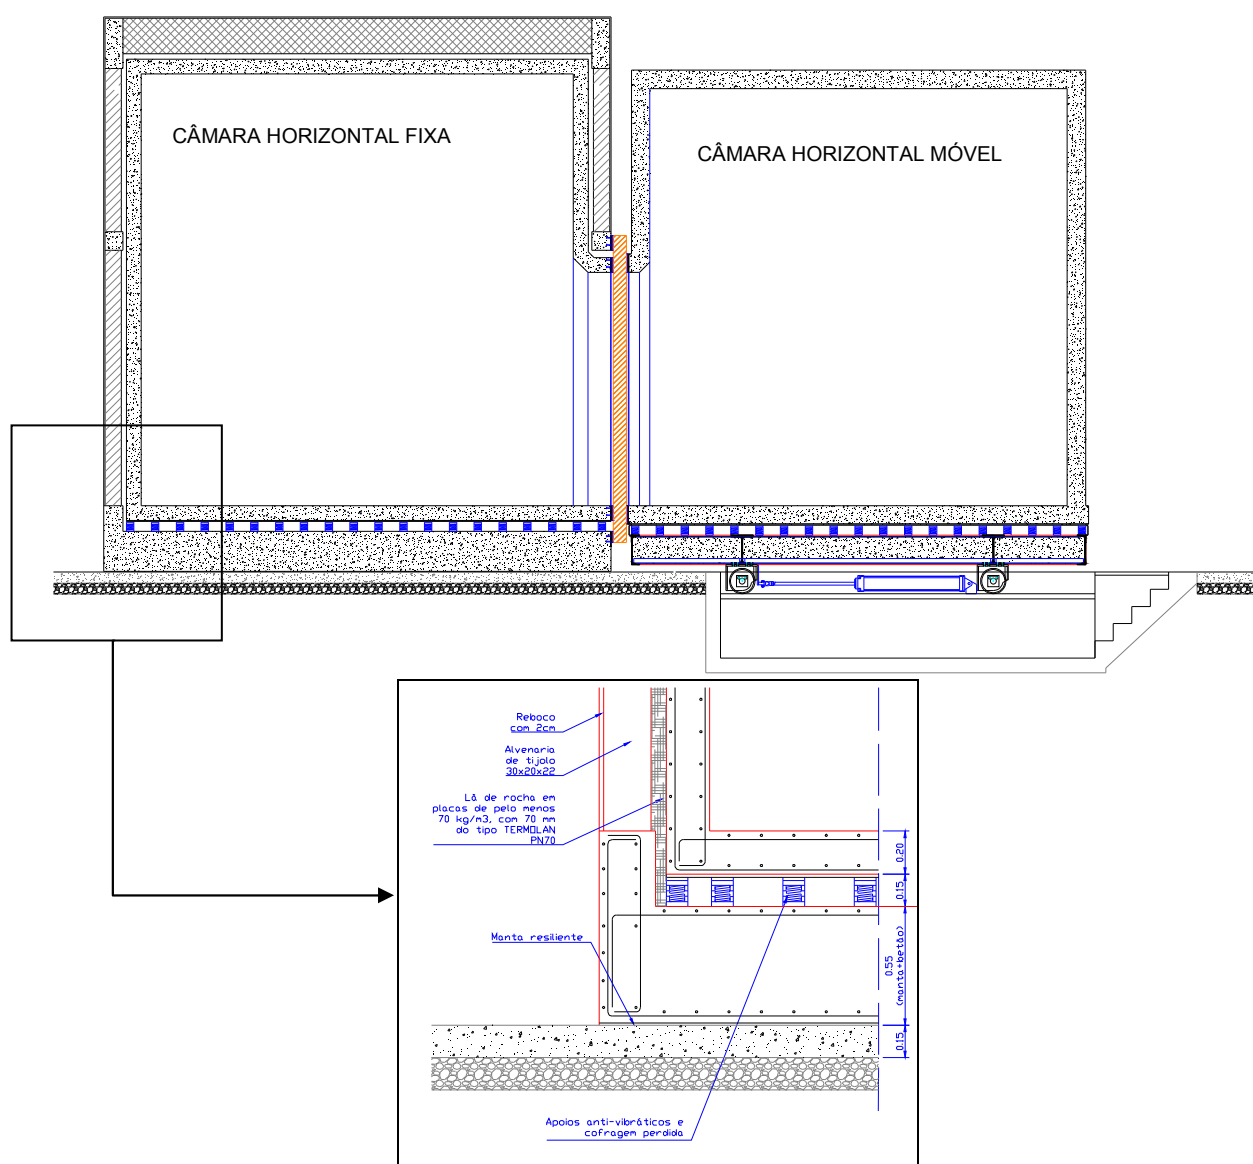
Sistema de isolamento de vibrações da câmara horizontal fixa
